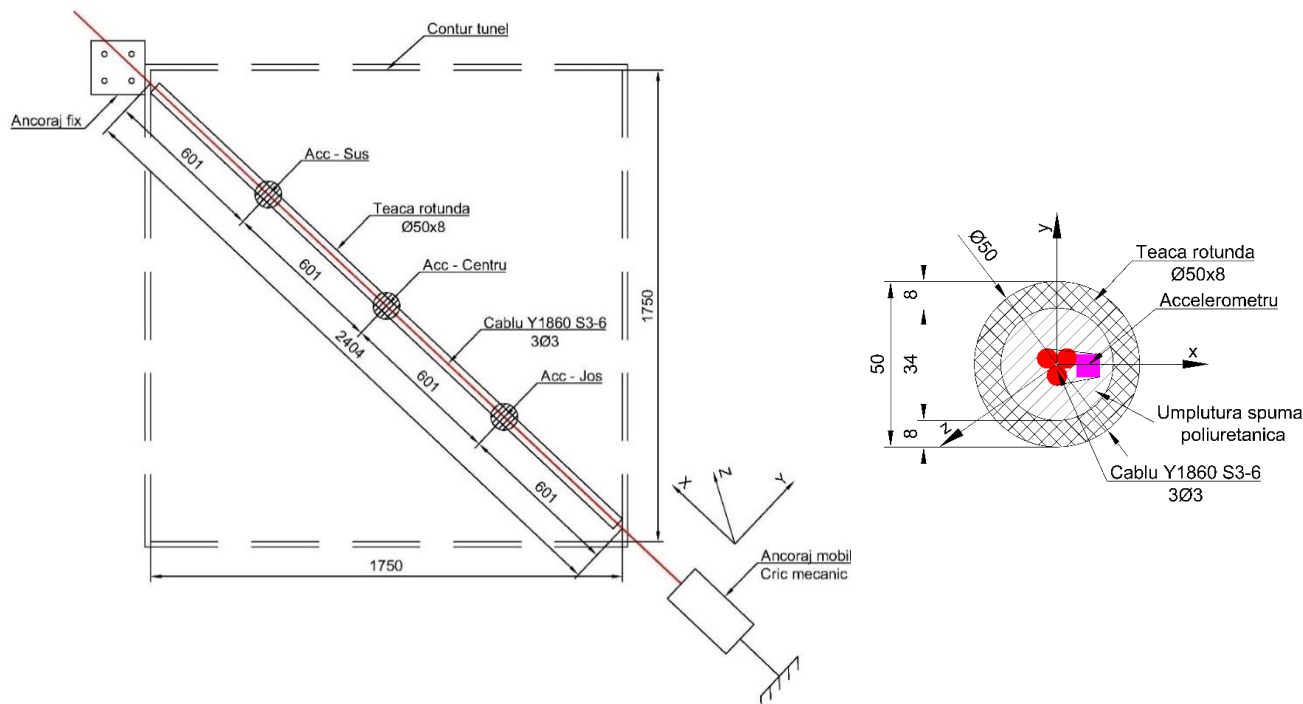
Schiță cu modelul la scară și secțiune prin cablu
